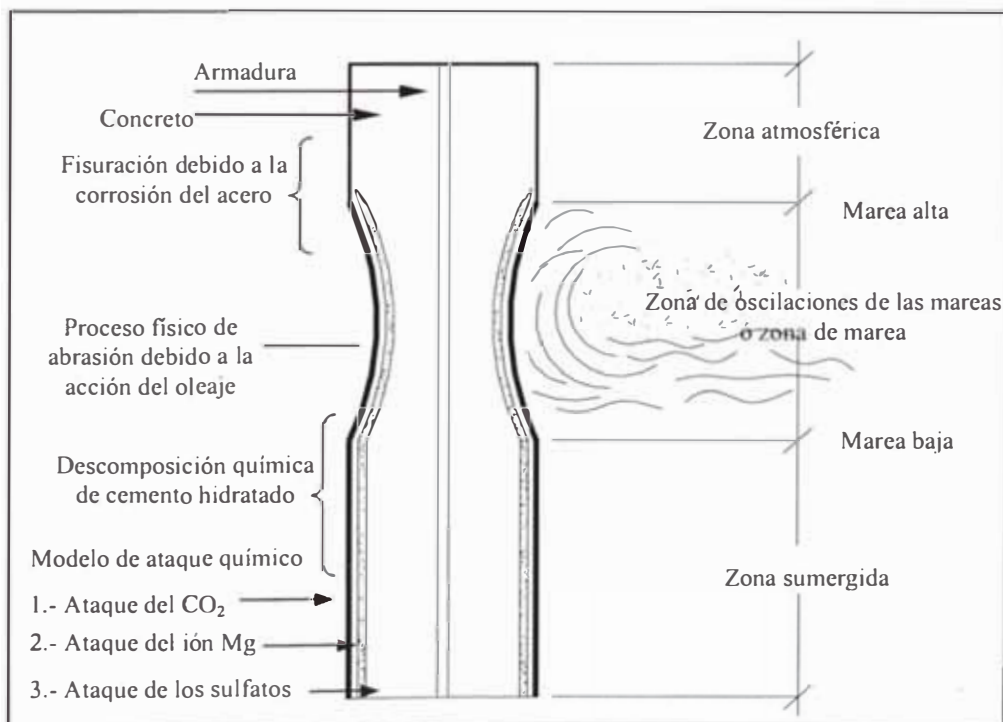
Zonas de exposición marinas de estructuras de concreto (Según P.K. Metha – Publicación ACI SP-65)
